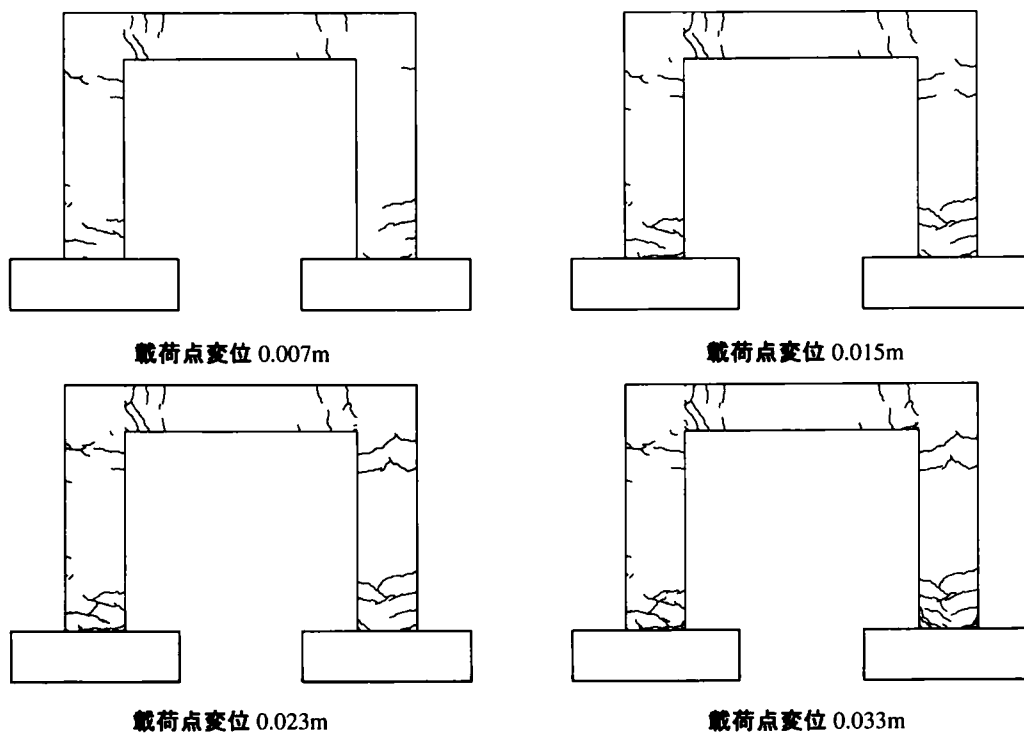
UBRC-2 供試体のひび割れの進展状況
